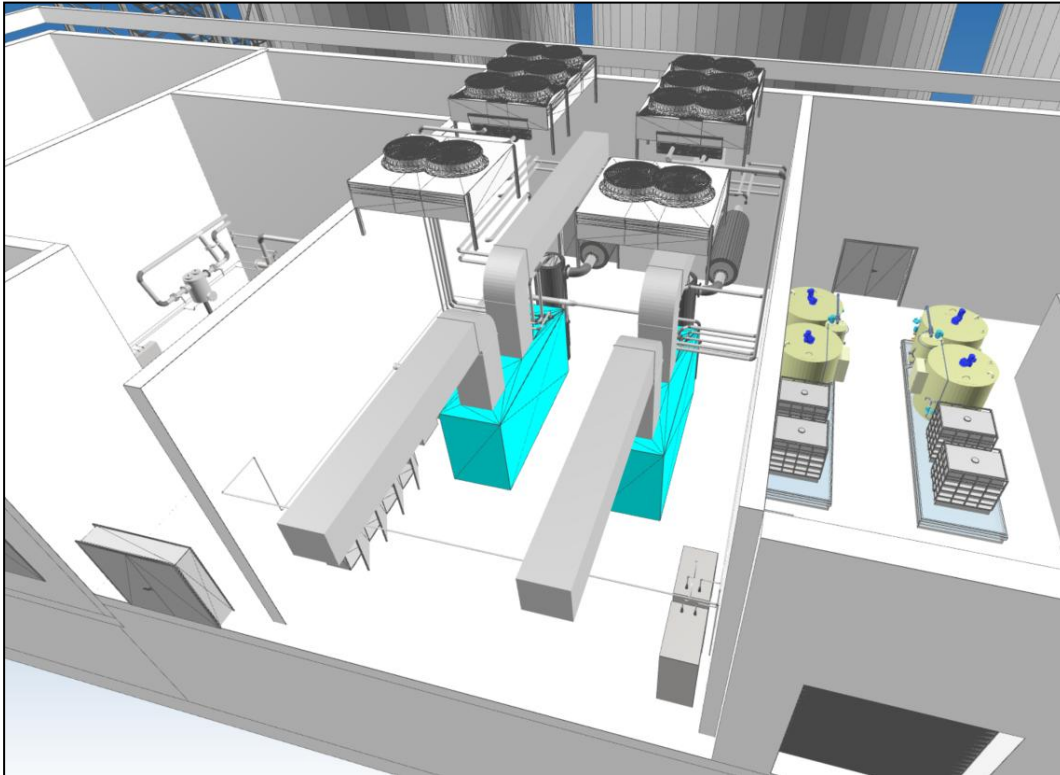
Modellausschnitt BHKW-Anlage mit auf dem Dach des Schlammgebäudes aufgestellten Freikühlern.
